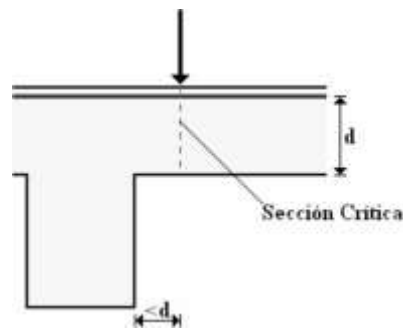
Sección Crítica a Cortante Tipo Viga en Losas
